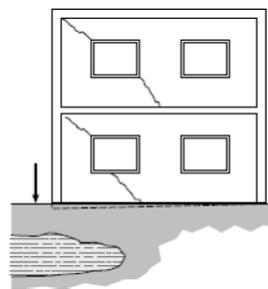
Ascensão de fissuras (SAMPAIO)
